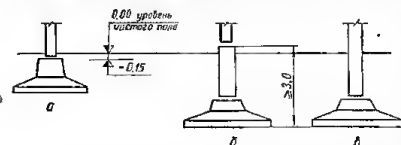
Схемы сопряжений колонны с фундаментом: а — на нулевой отметке при малом заглублении фундамента; б, в — при большом заглублении фундамента.
